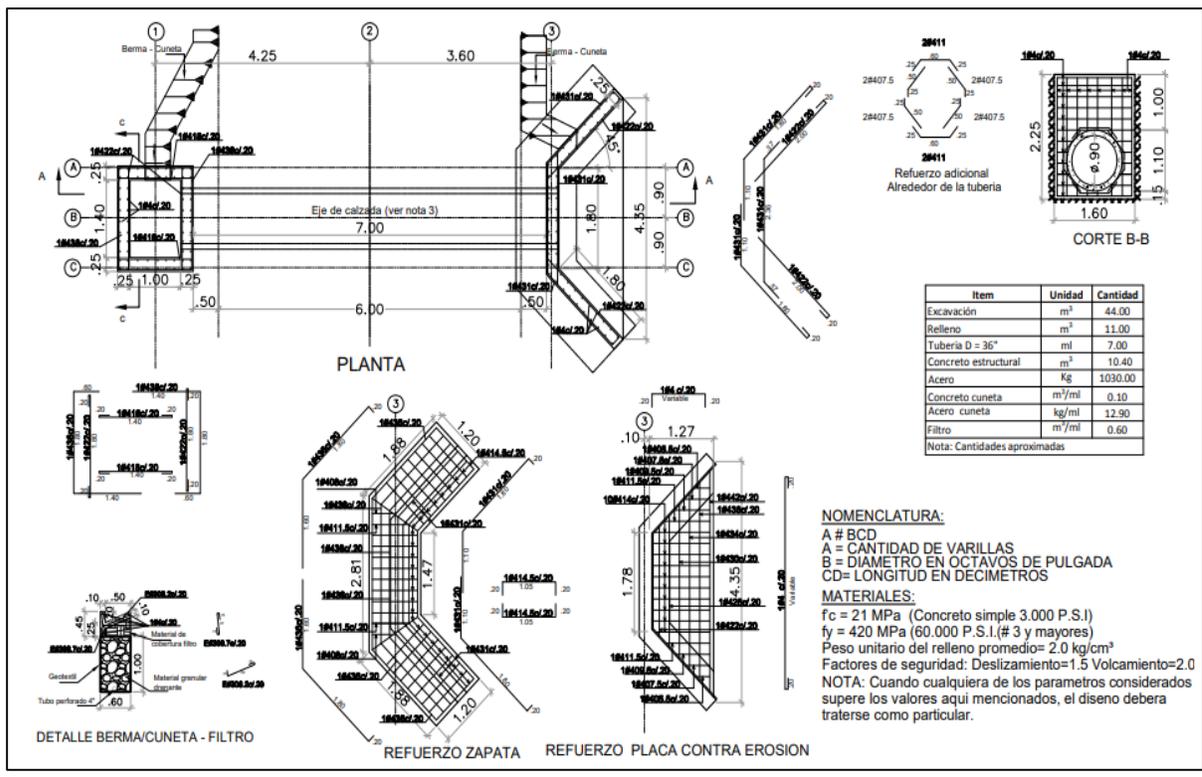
Detalle refuerzo Alcantarilla con muros en concreto reforzado Poceta – Aleta. Fuente Cartilla red terciaria INVIAS
